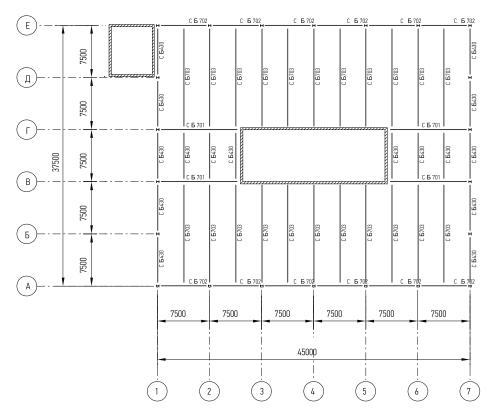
Вариант каркаса с применением стальных конструкций при сетке 7,5х15 м. Маркировочный план несущих конструкций перекрытия типового этажа (уровни 3–18)
